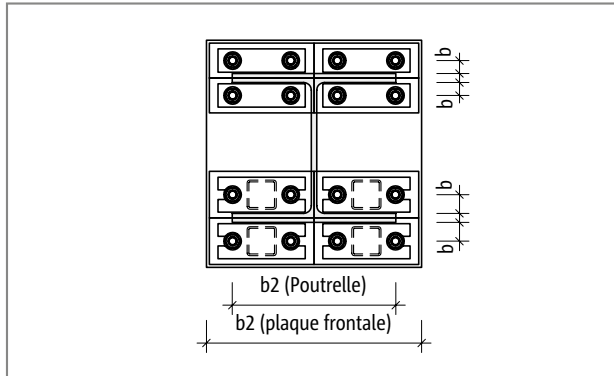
Plaque frontale T type S : tableau des entrées géométriques ; vue globale
